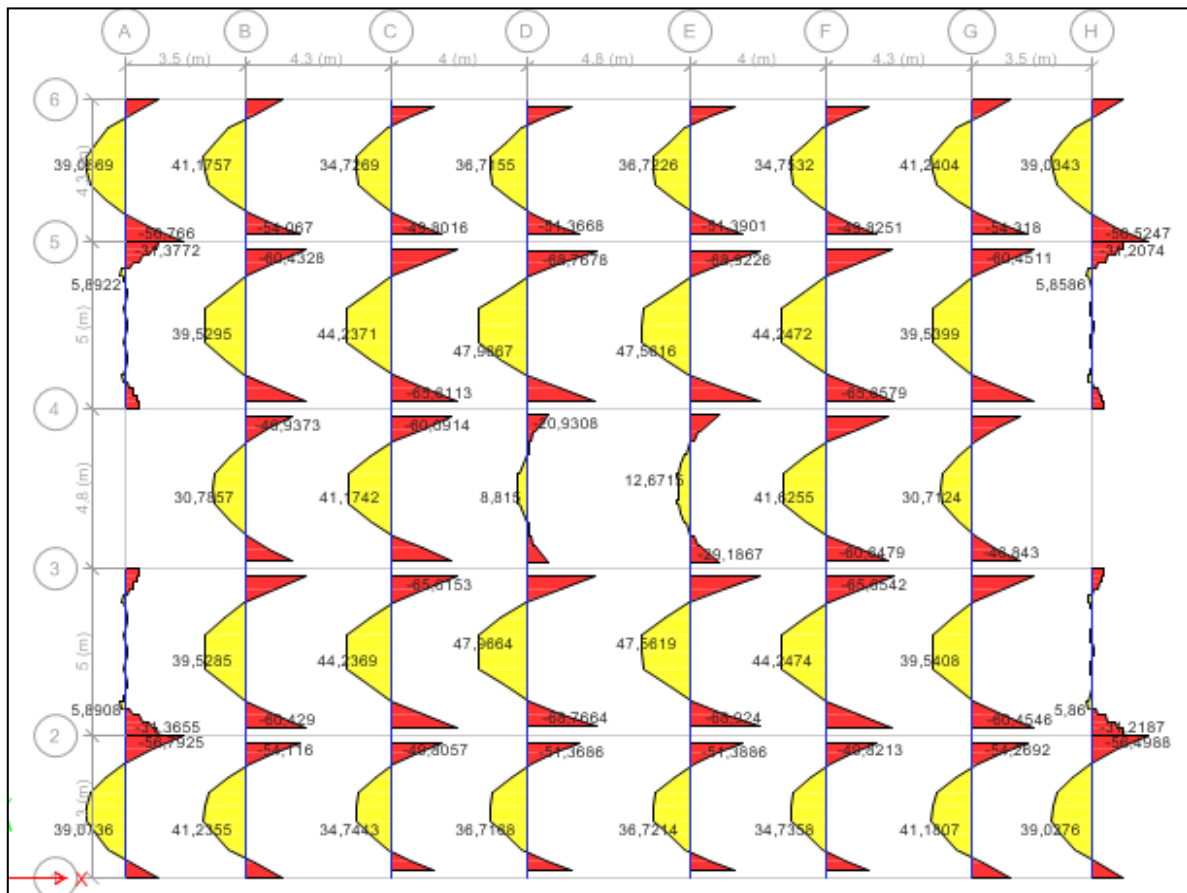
Moment fléchissant des poutres principales (ELU)
